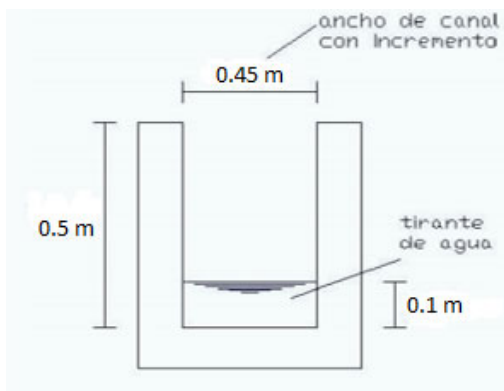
Sección del canal de las rejillas para la planta. Fuente: Grupo de Investigación.
